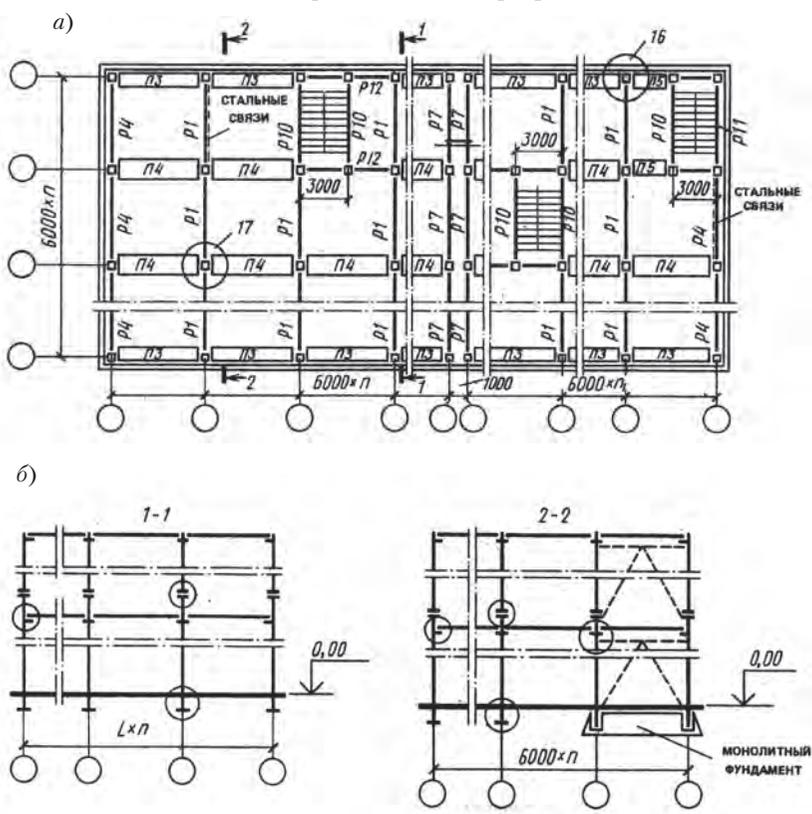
Схема расположения ригелей и связевых плит в перекрытиях здания с сеткой колонн 6x6 м и (6+3+6) м:
